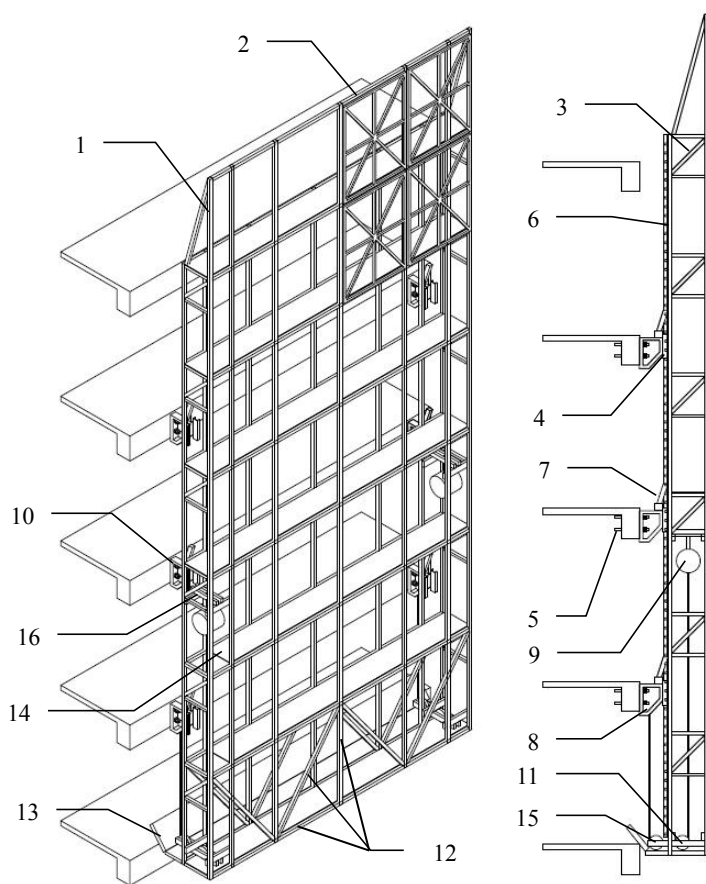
常见中心提升式附着升降脚手架示意图
